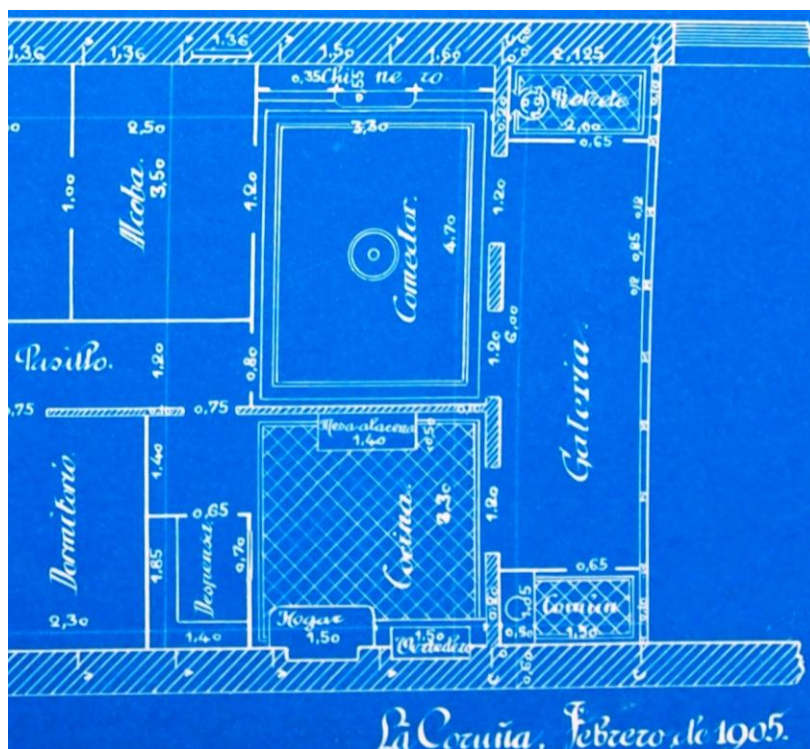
Proyecto para la Plaza de Lugo, 13 (1905). Detalle de la zona de servicio en la que aparecen indicados los muebles, pavimentos y techos de escayola.
